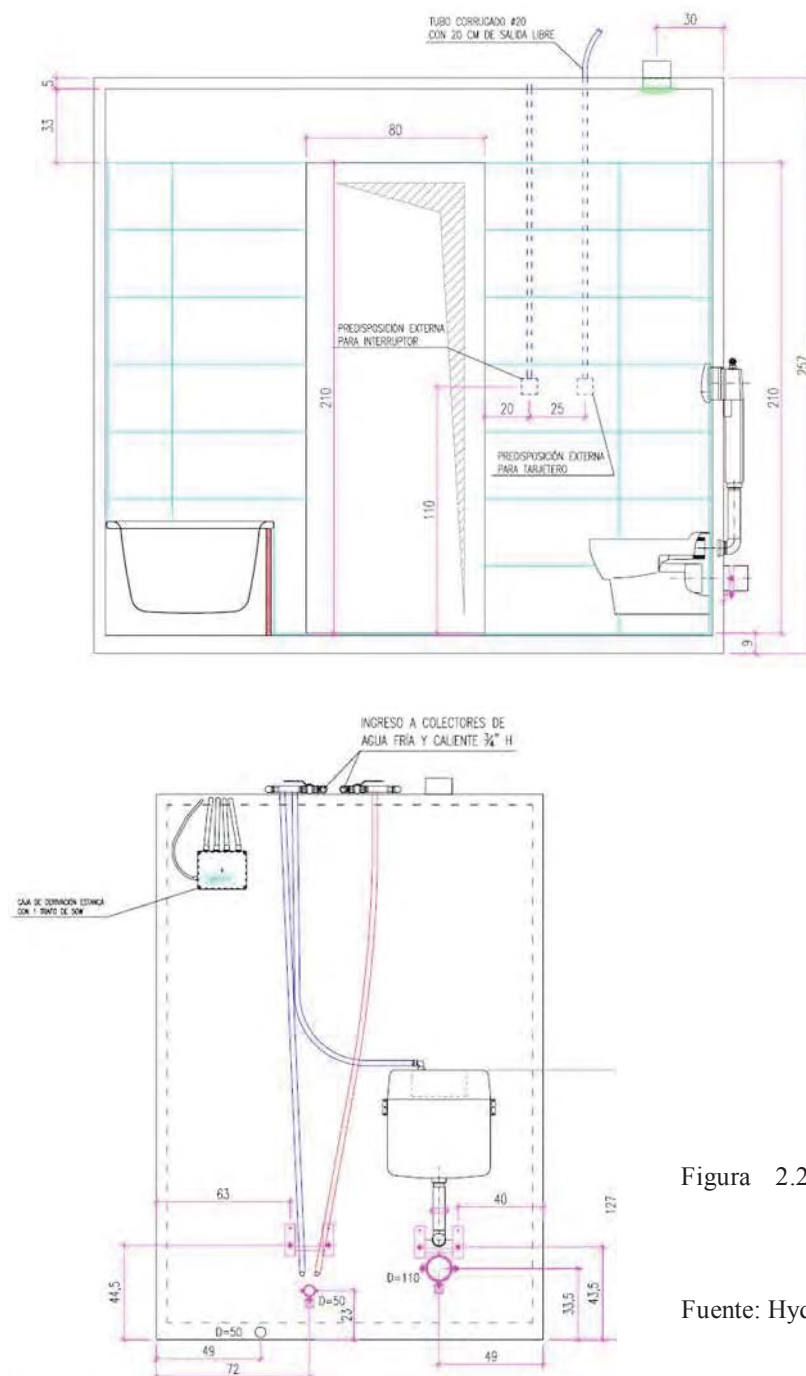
Planos de alzados de baño prefabricado para hotel en Sureste peninsular español
